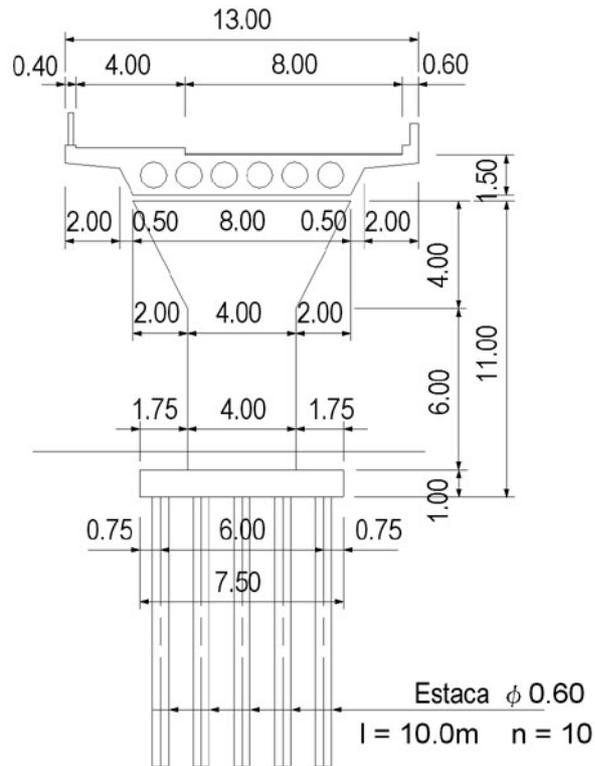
Seção Transversal Proposta para a Estrutura da Ponte
